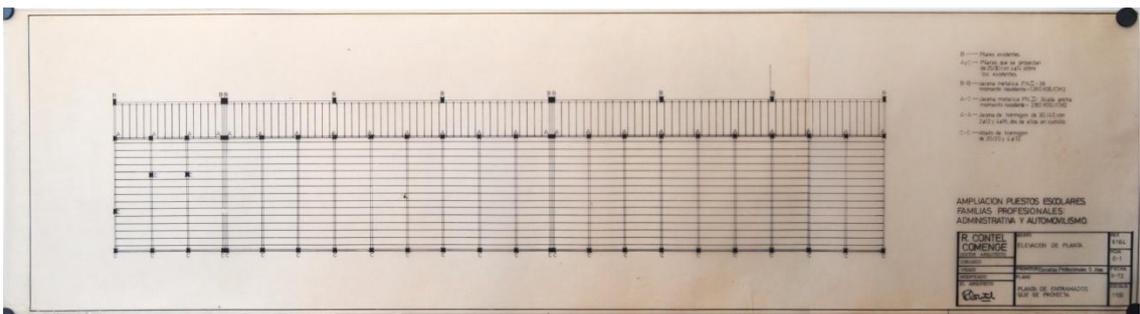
Plano estructura ampliación planta primera del taller. *Archivo Escuelas San José.
